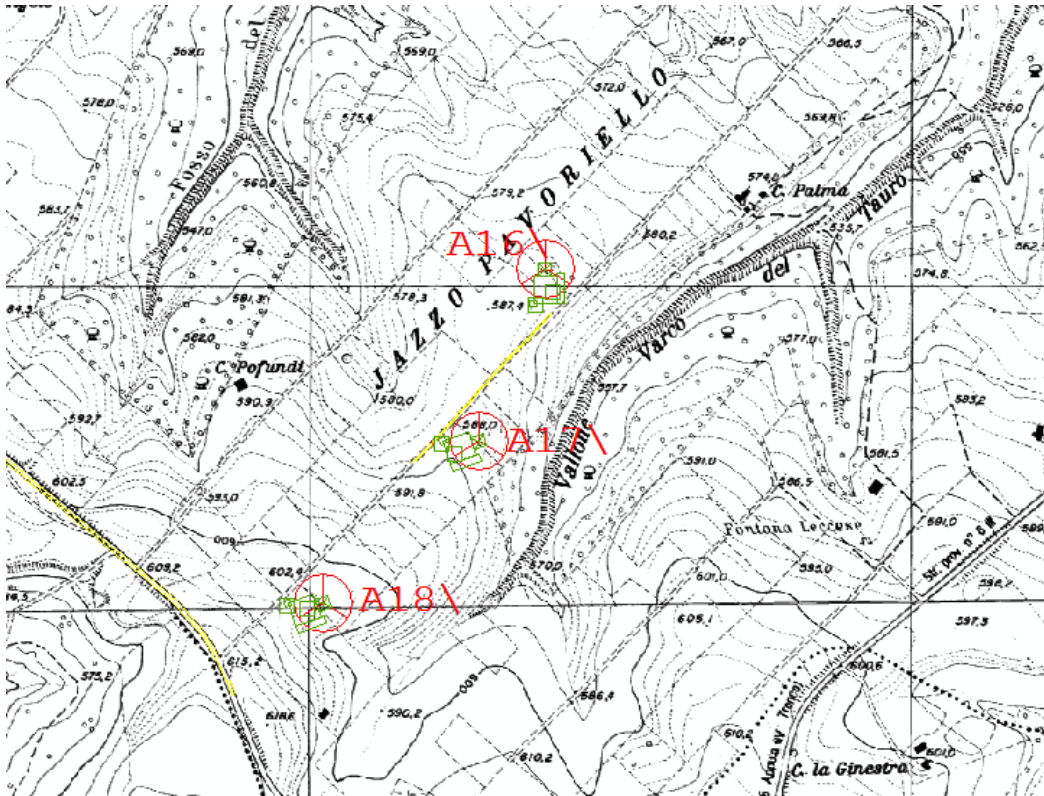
Particolare di Strade e Piazzole interessate dalla costruzione del parco su CTR.
